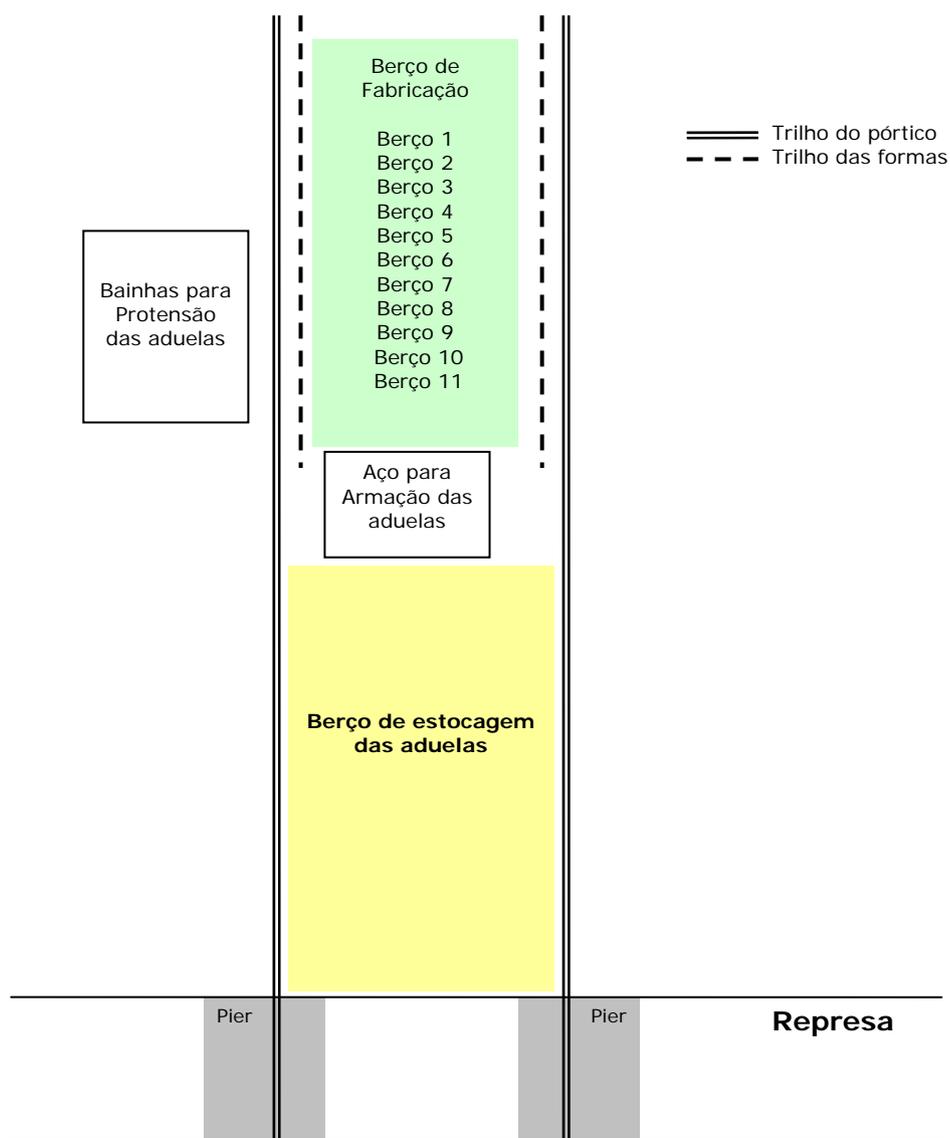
Layout* do pátio de fabricação das aduelas pré-moldadas.
